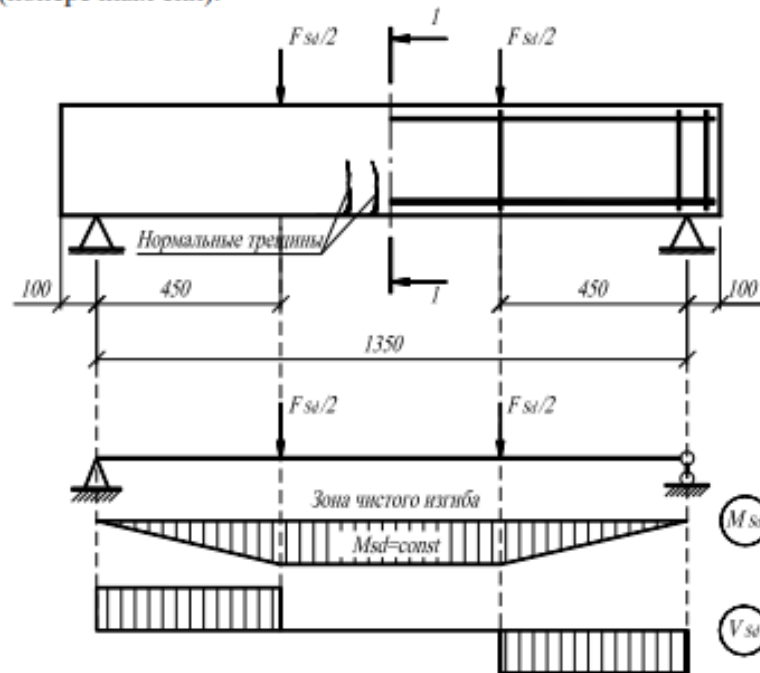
Схема испытания балки с эпорами усилий
